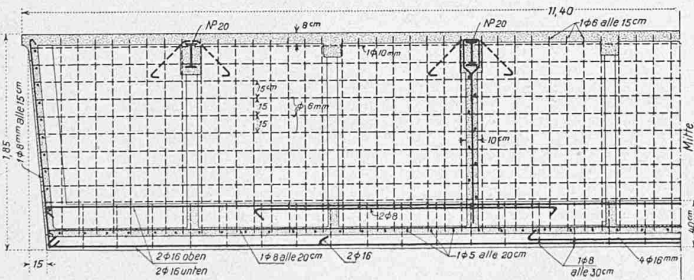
Ponton-Armierung. — Längsschnitt 1:60.
